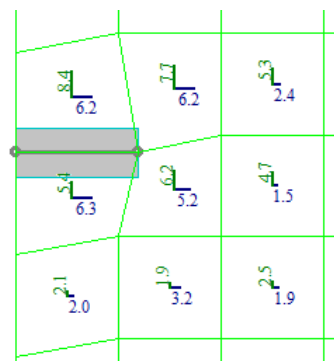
Армирование у верхней грани плиты в графическом и цифровом виде (фрагмент)
